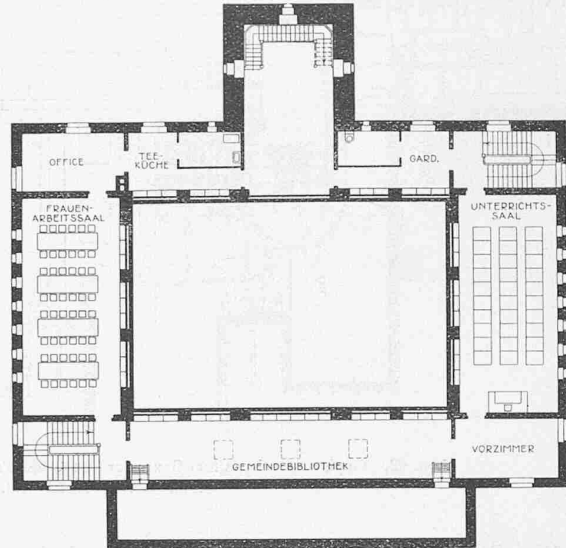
Grundriss vom Dachstock. — 1 : 400.
